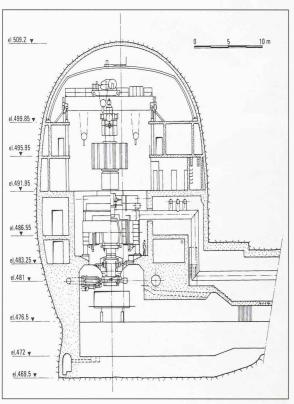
Usine souterraine de Bieudron: coupe de la caverne principale abritant la salle des machines
